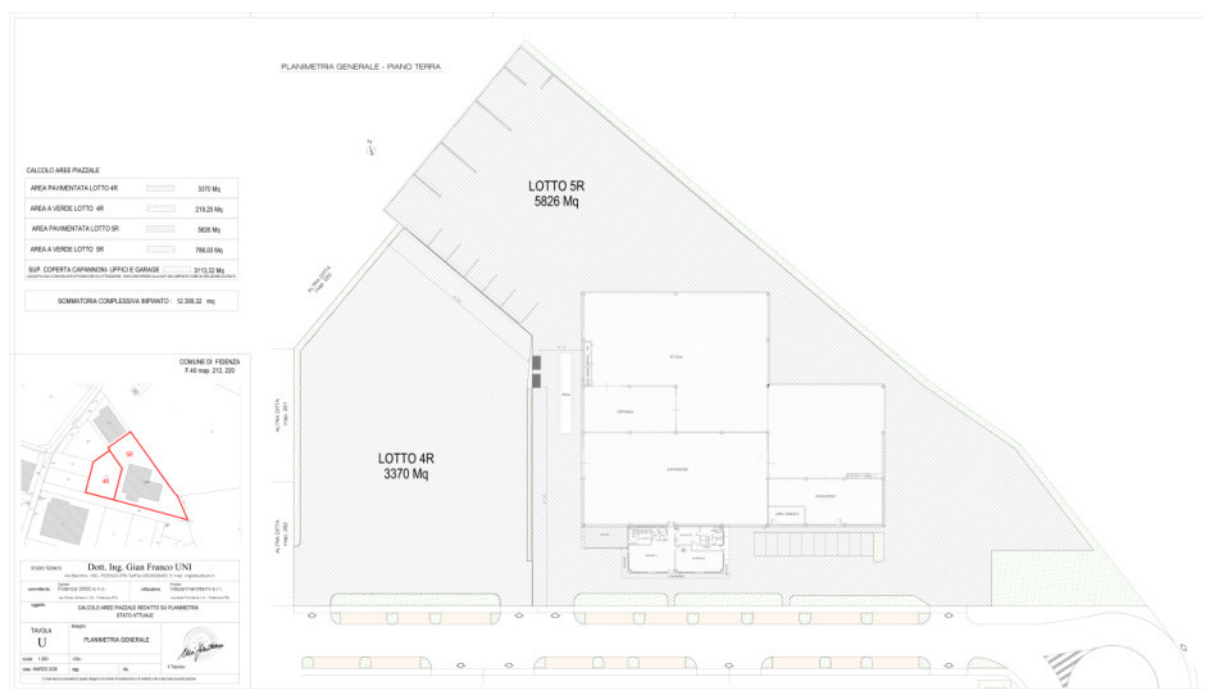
Tavola U Planimetria generale – Calcolo aree piazzale redatto su planimetria stato attuale (fuori scala).
